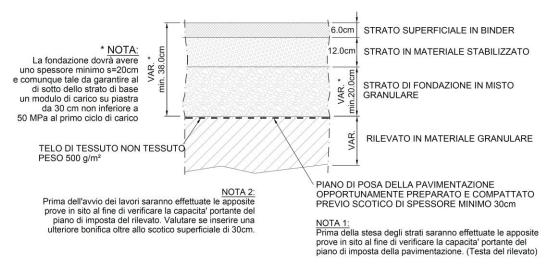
Dettaglio pavimentazione della strada di accesso all'imbocco GN01.
